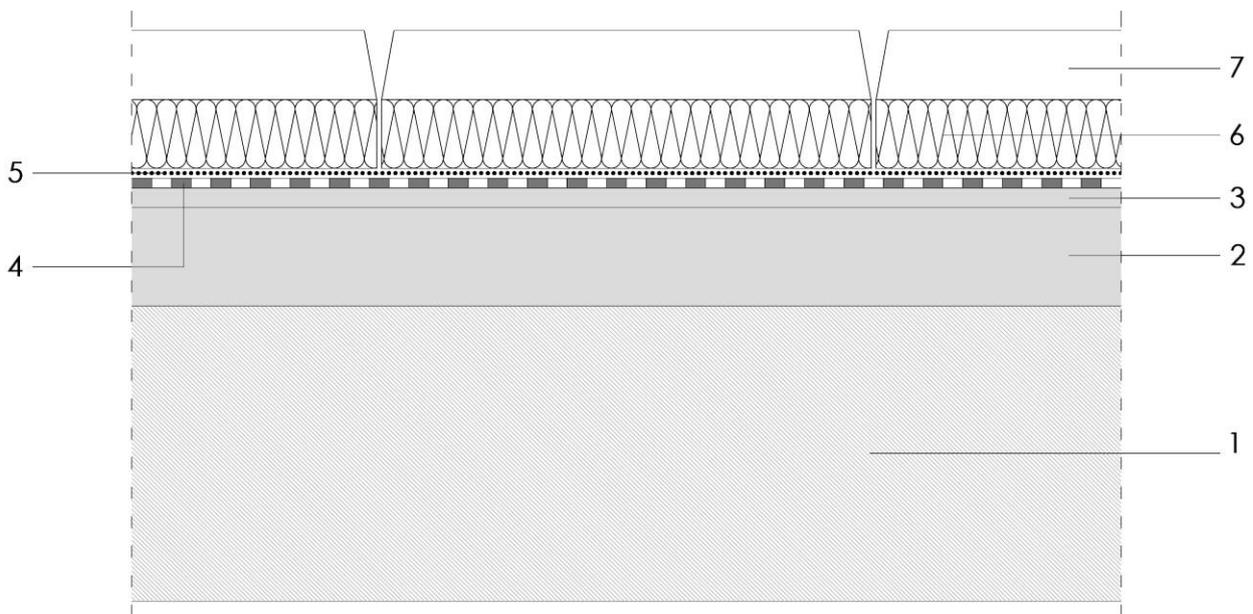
Detalle constructivo de cubierta inundada con protección de losa aislante.
